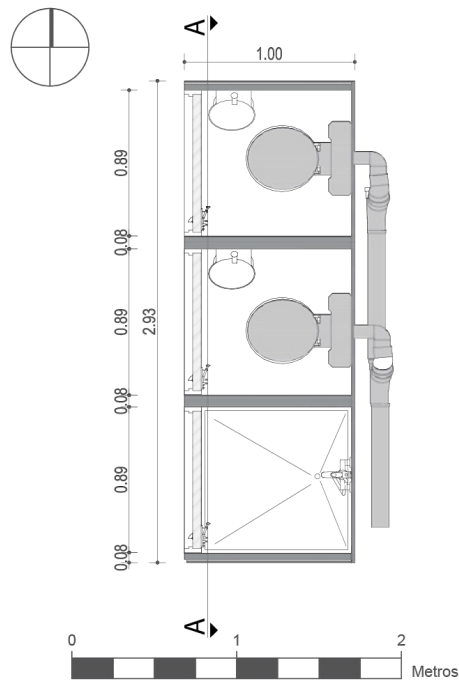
Folding Shelter Housing Zona de aseo. Elaboración: Autores
